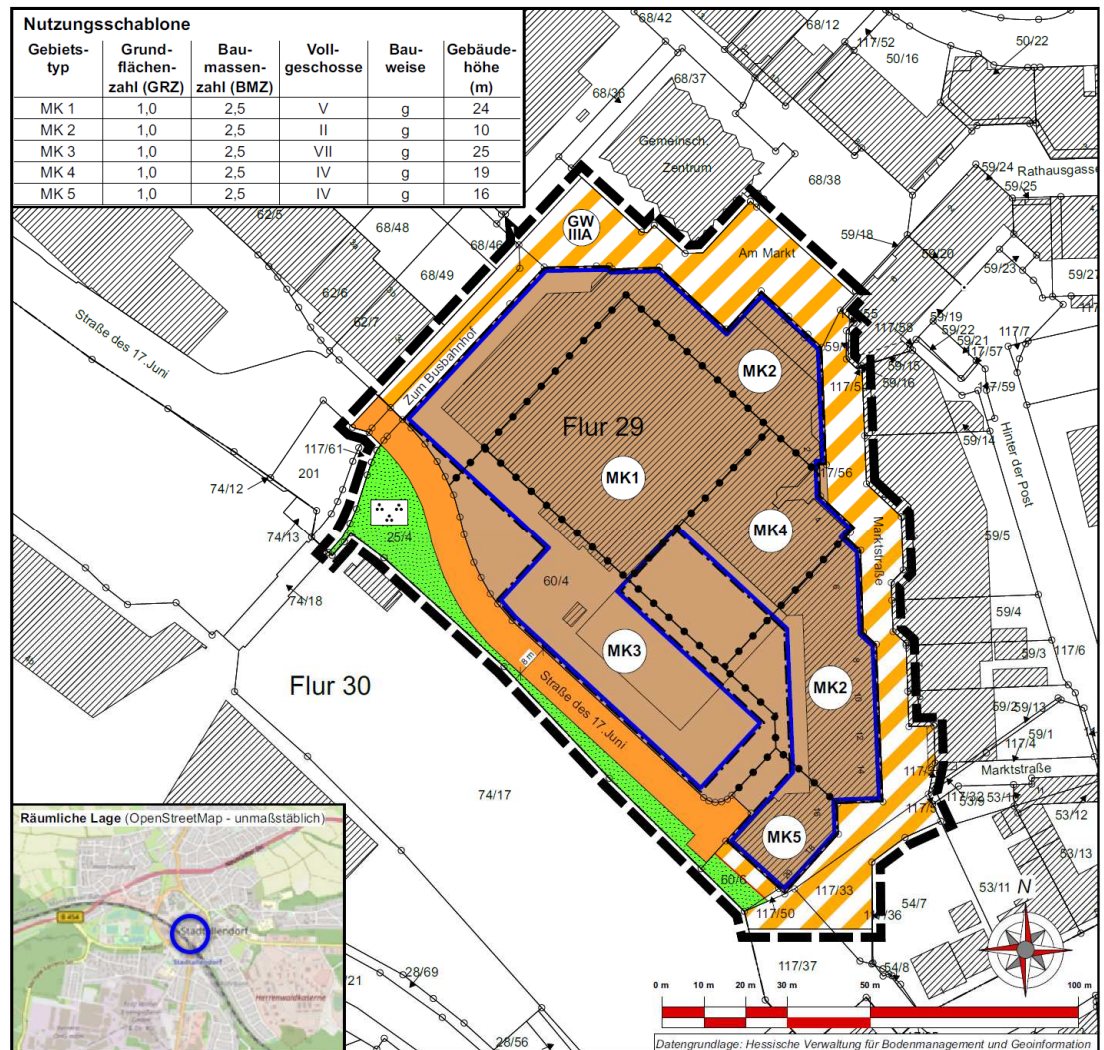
Vorentwurf des Bebauungsplan, Planteil.
